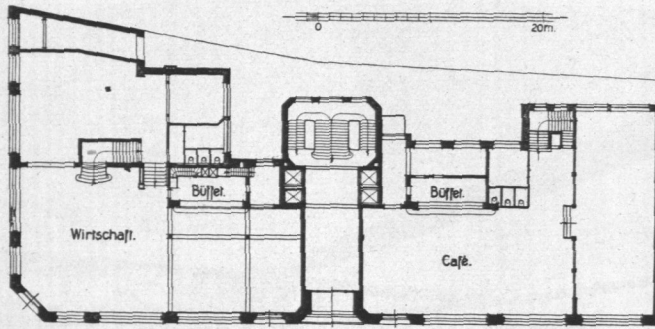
Restaurant und Café Klosterburg, Grundriß.
